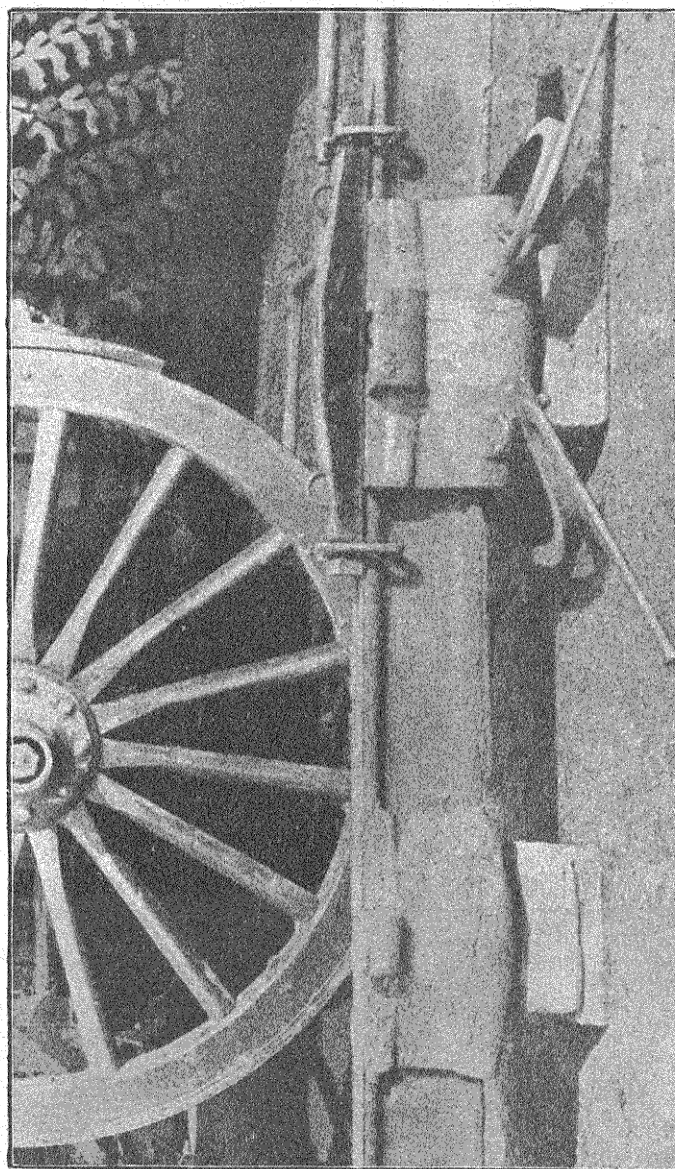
Joint coulé et moule disposé pour recevoir la fonte.
